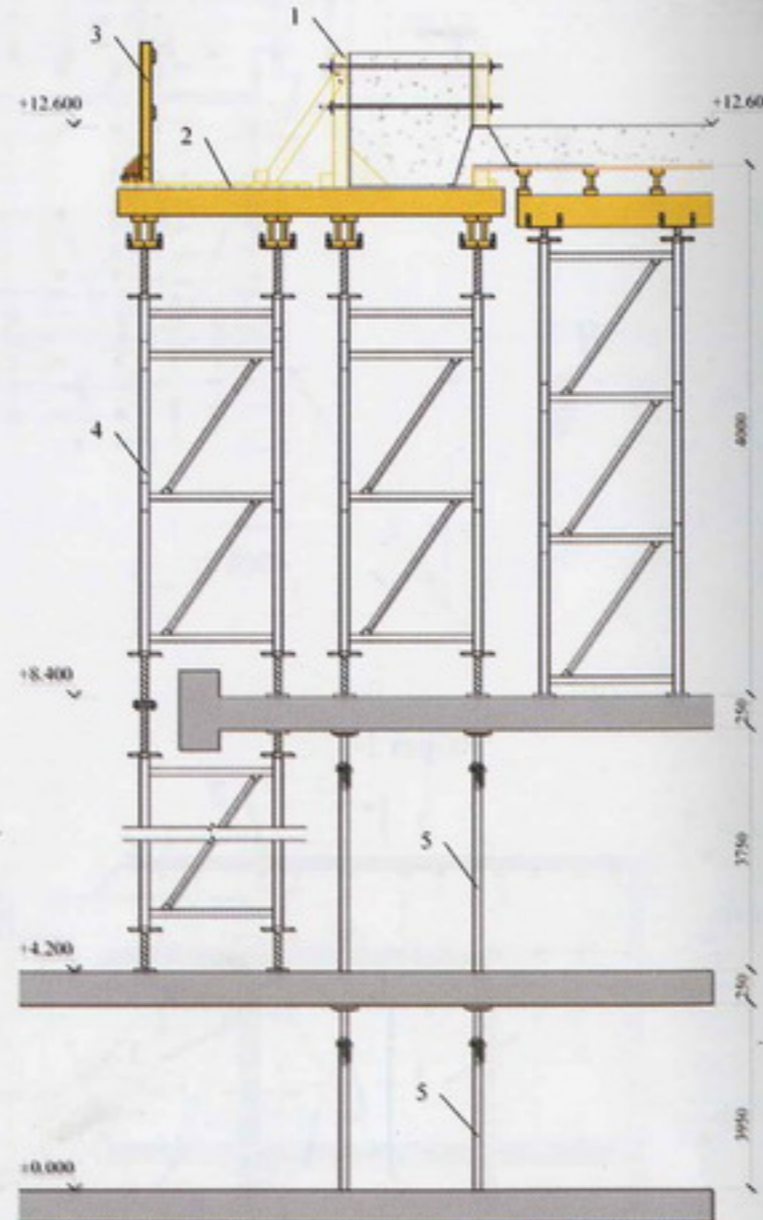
Схема опалубки обвязочной балки и монолитного перекрытия на отм. +12,600 центрального ядра высотного книгохранилища:
